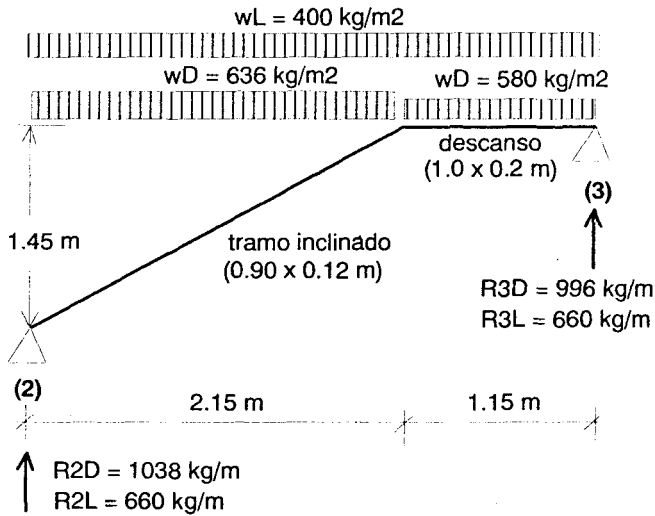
Cargas por Unidad de Ancho y Unidad de Longitud Horizontal en un Tramo de la Escalera y Reacciones en las Vigas de Apoyo.
